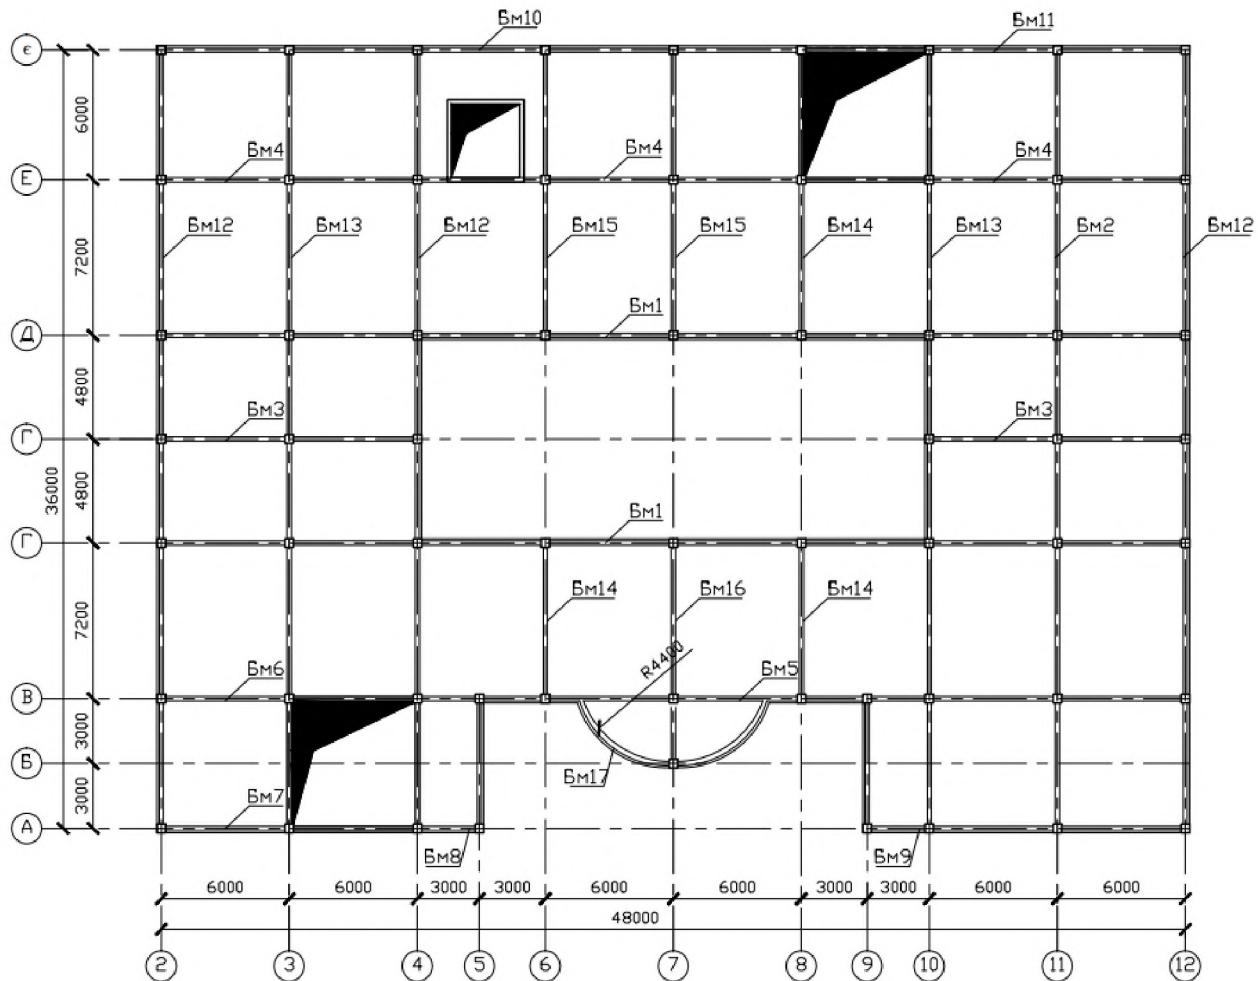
Опалубочне креслення монолітного перекриття на відм. +4.200
